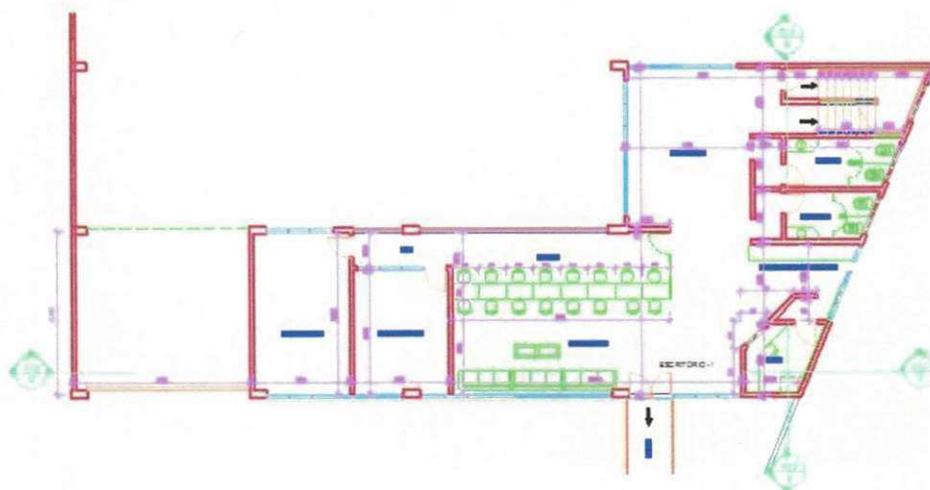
Planta baixa 2º pavimento dos escritórios.
